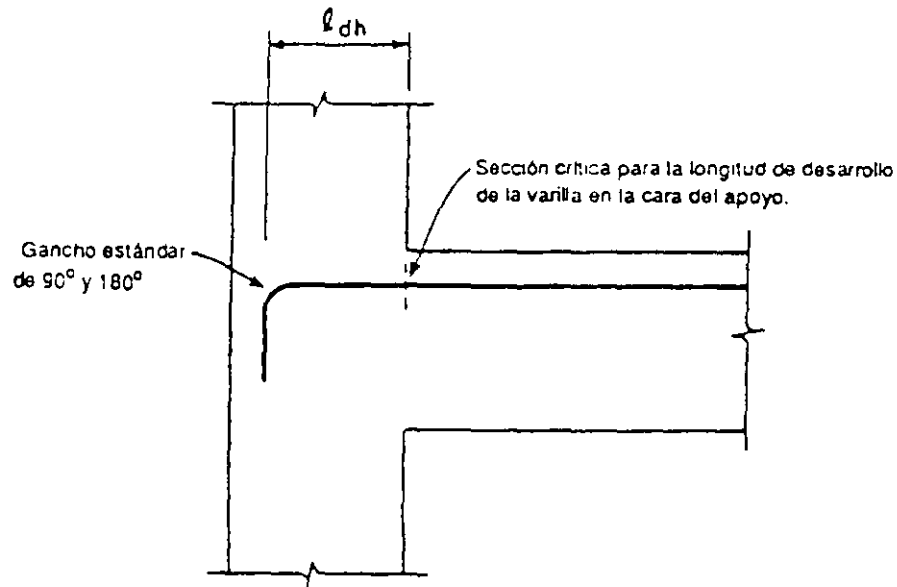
Anclaje dentro del apoyo exterior con un gancho estándar.
